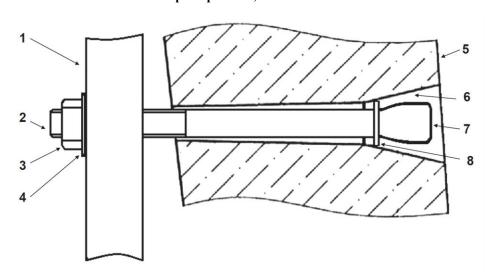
Крепление кронштейна типа ККП с помощью ершей с резьбой: 1 — кронштейн ККП; 2 — ёрш, конец с резьбой М12; 3 — гайка М12; 4 — шайба; 5 — боковая стена колодца; 6 — отверстие для ерша; 7 — ёрш, расплющенный конец; 8 — шайба.
